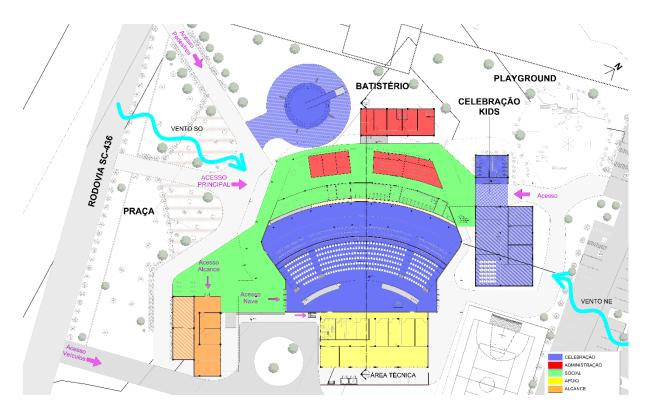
Implantação com a planta baixa do térreo e indicação dos setores. Fonte: Elaborado pelos autores.
